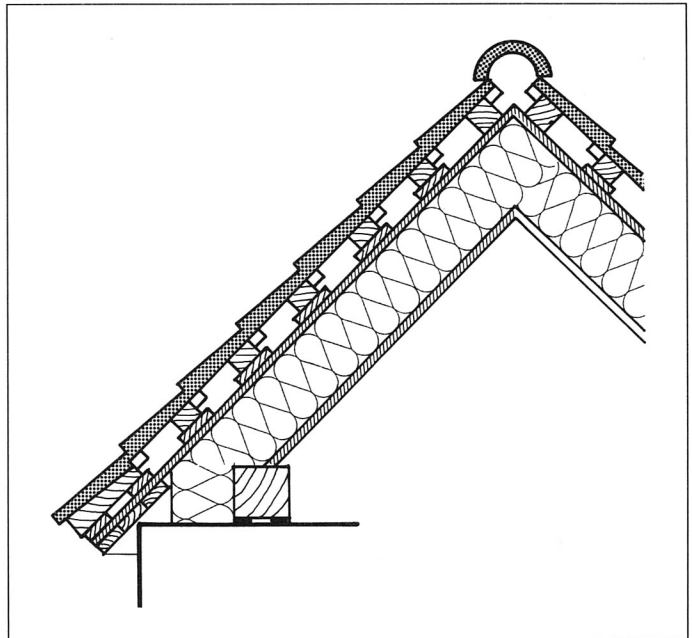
Schematische Darstellung eines geneigten Daches mit Wärmedämmung zwischen den Sparren nach den neuen Gesichtspunkten. Ein Luftaustausch zwischen unterschiedlich orientierten Dachflächen ist zu vermeiden. Eine Belüftung zur Trockenhaltung der Dachlatten ist durch die vorhandenen Undichtheiten der Dachdeckung (Dachziegel, Dachsteine) ausreichend. Zum ungehinderten Ablauf eingedringenen Wassers ist bei vorhandener Vordeckung ein Abstand zwischen dieser und den Dachlatten einzuhalten. Bei Unterspannbahnen mit Durchhang (nicht voll gedämmter Sparrenraum) erübrigt sich dies. Die raumseitige Beplankung der Sparren muß luftdicht und ihr Diffusionswiderstand auf den des äußeren Abschlusses abgestimmt sein.
